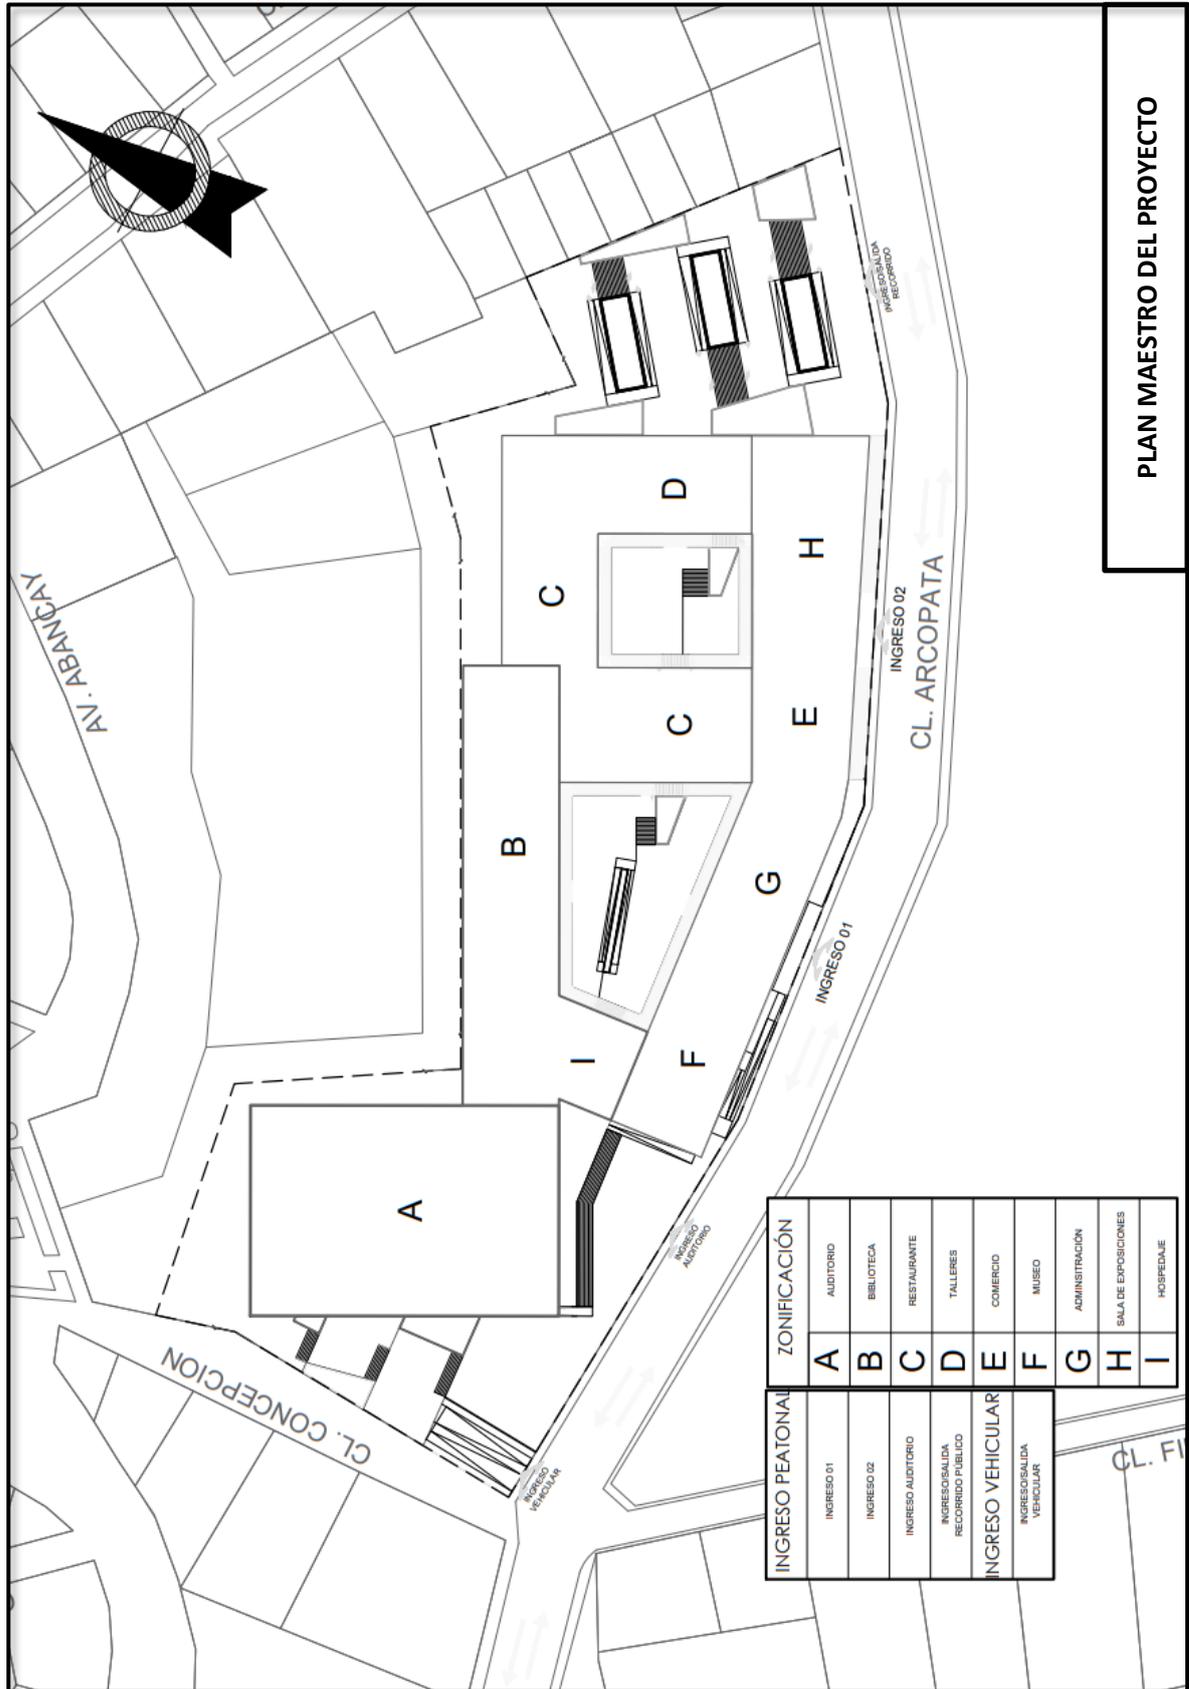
PLAN MAESTRO URBANO DEL PROYECTO
